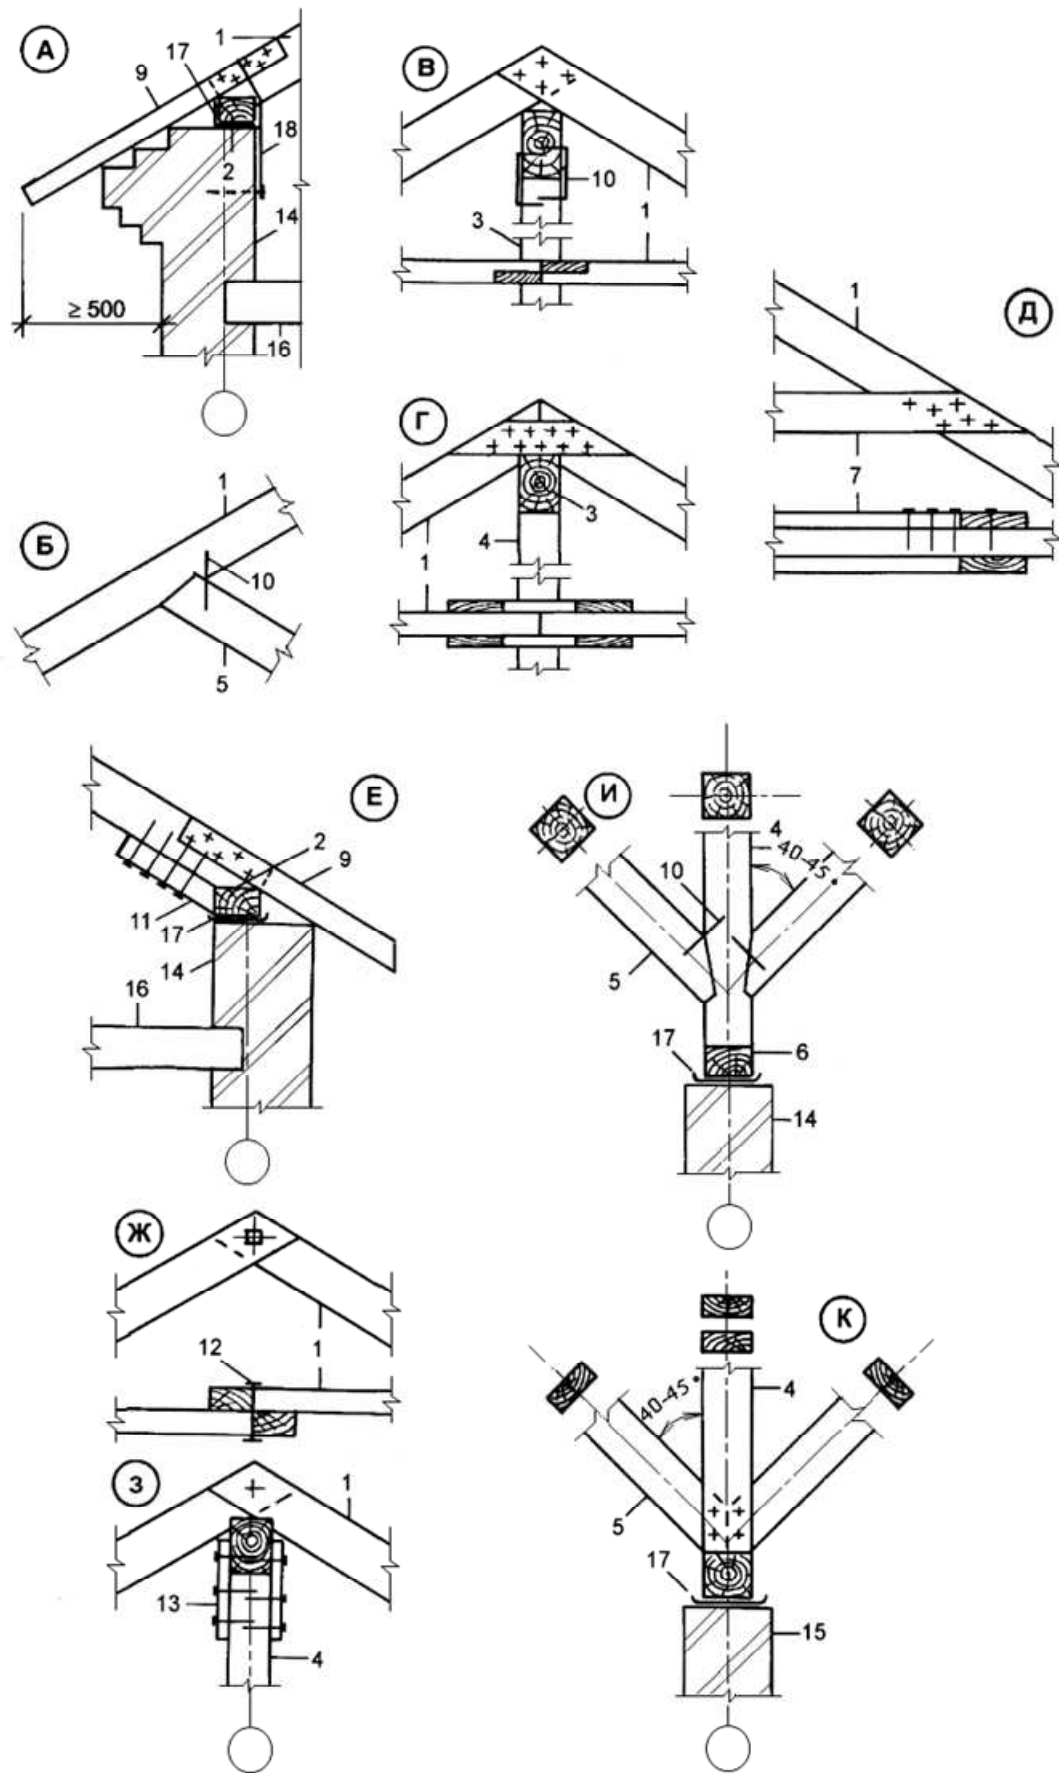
Узлы стропильных конструкций двухскатных крыш:
